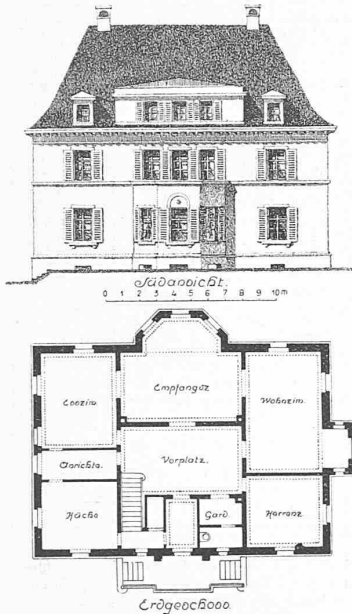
bis 13. Grundriss mit Fassade, 1:400, und West-Ansicht zweier Wohnhäuser an der Kantstrasse. — Architekt Prof. Dr. K. Moser, Zürich.
